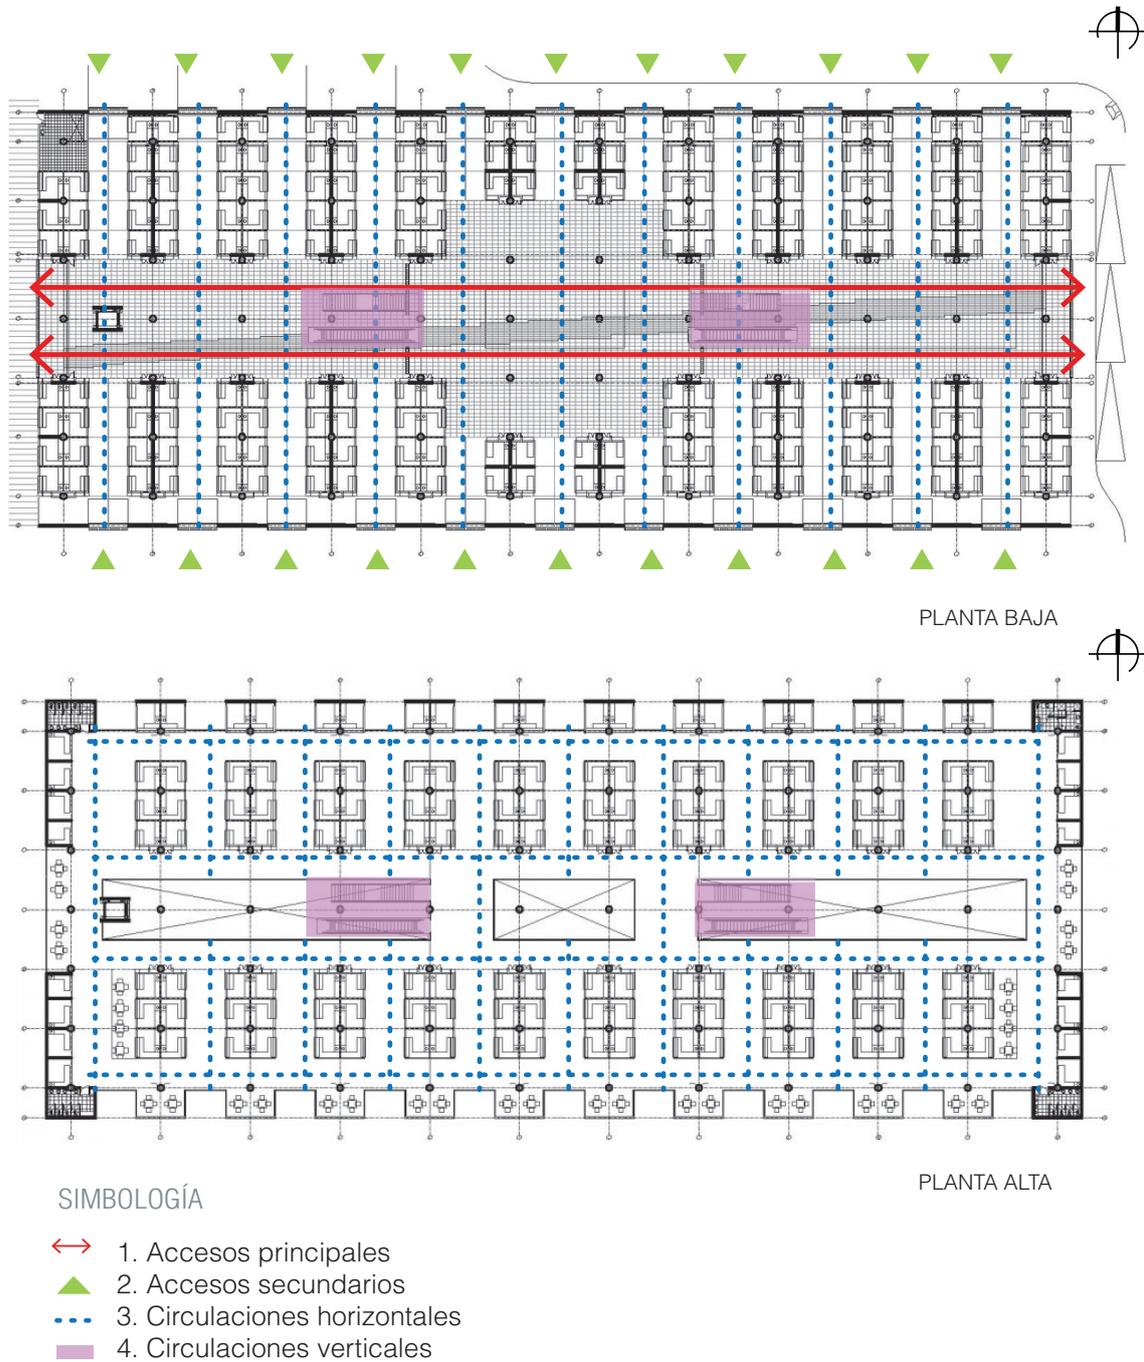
Planos del Mercado Tirso de Molina con análisis de circulaciones y accesos. Foto. Pedro Mutis. Fuente: Archdaily y análisis de circulaciones y accesos de elaboración propia.
